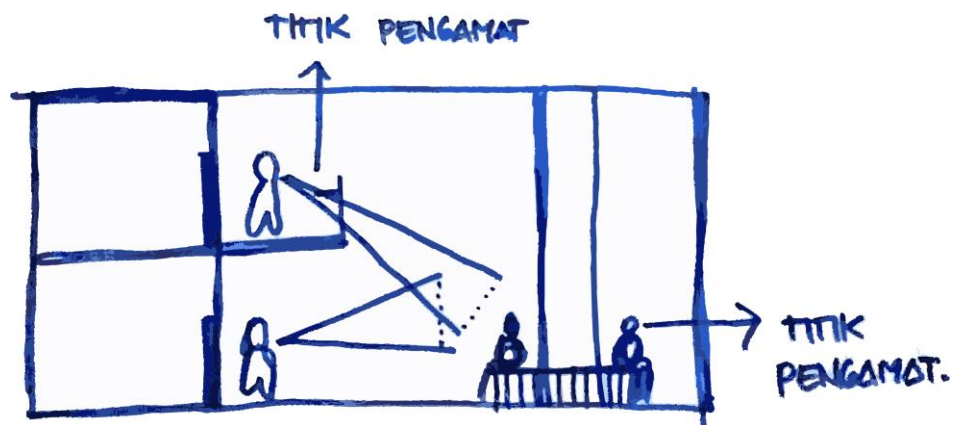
22 Final Desain Lobby Ruang Tunggu Kedatangan
